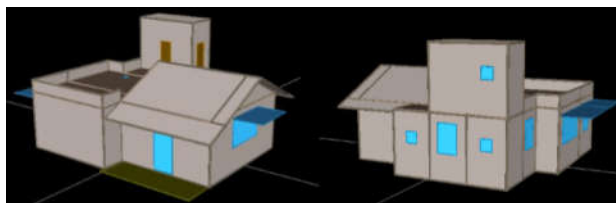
Modelagem da Planta Piloto Bioclimática da UFSC – Centro Araranguá. Retirado de [4].
